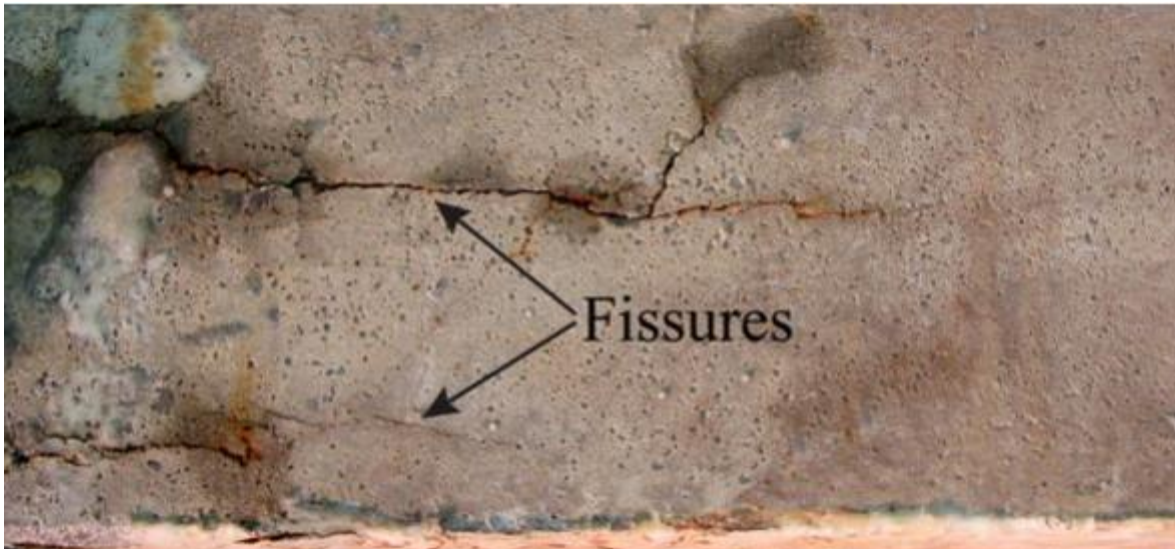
Fissuration causée par la corrosion des armatures
